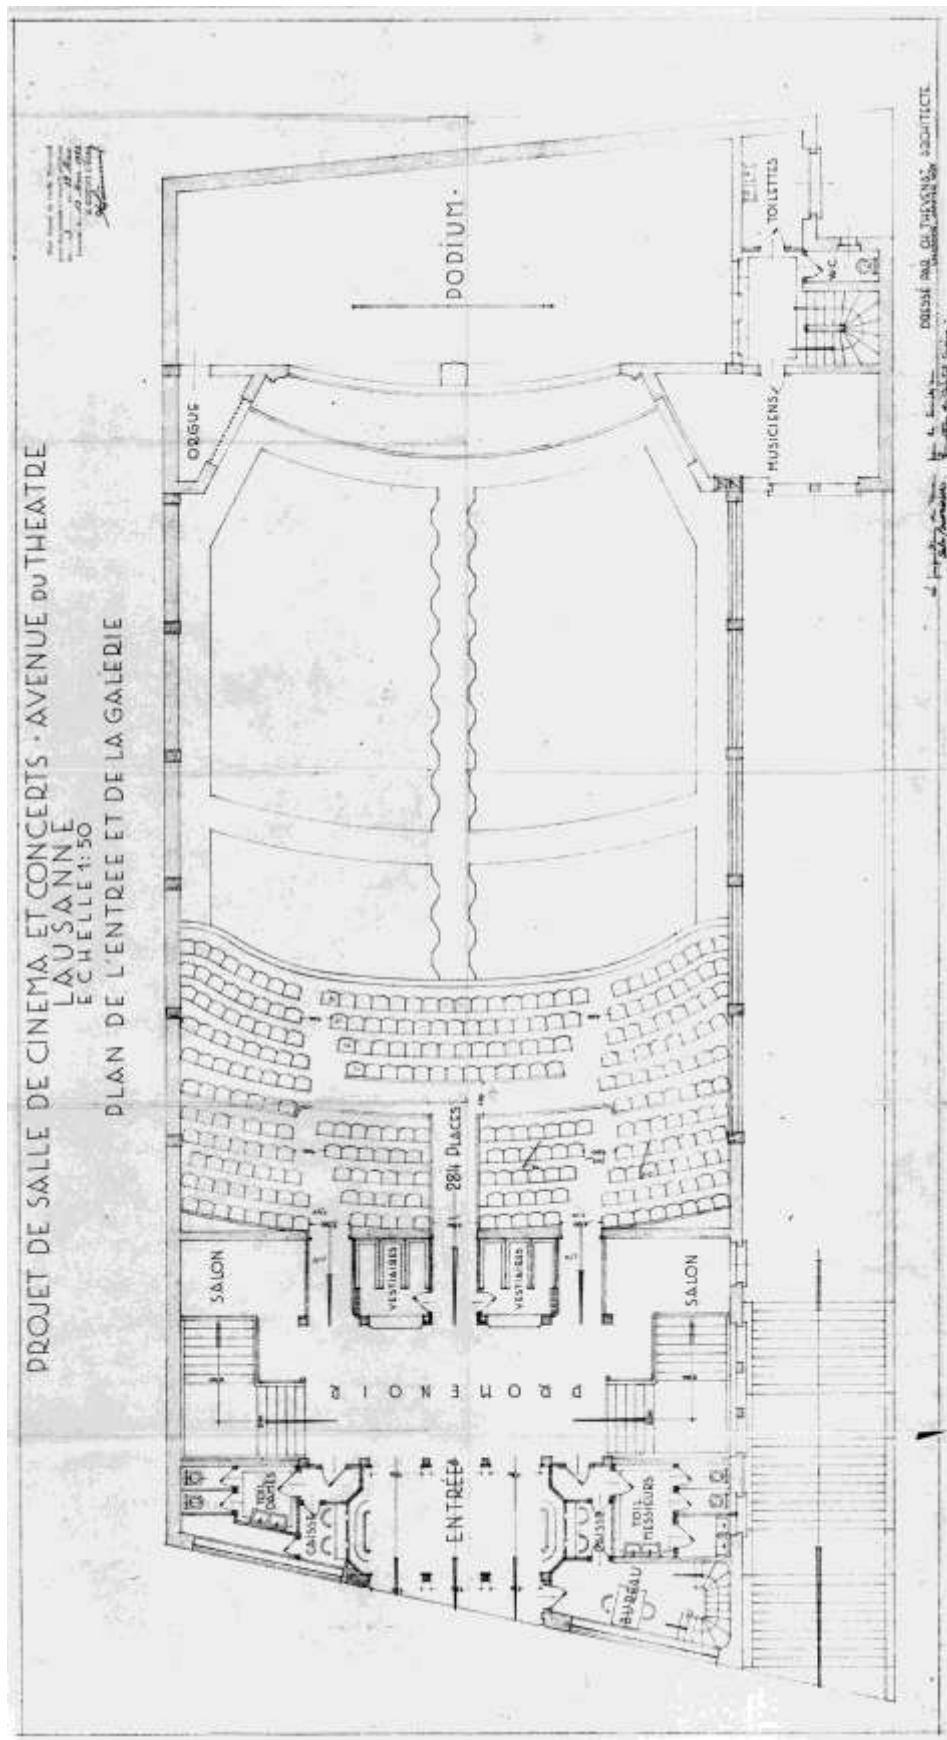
Plan de l'entrée et du balcon, Charles Thévenaz architecte, janvier 1928 (AVL).
